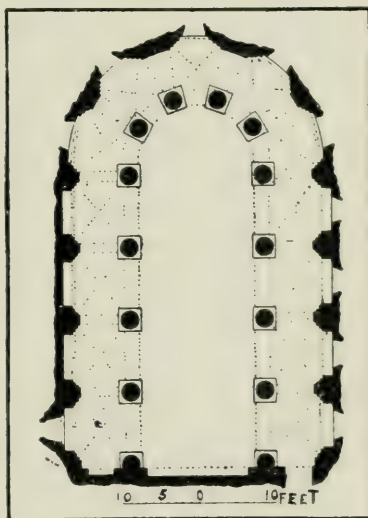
CHAPELLE SAINT-JOHN, A LA TOUR DE LONDRES. (Plan.)
